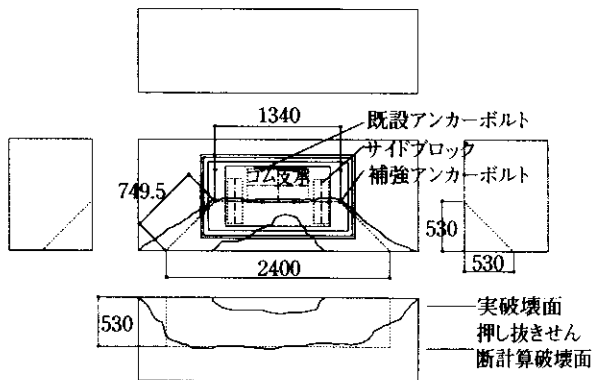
最終ひび割れ状況 (Eタイプ)
